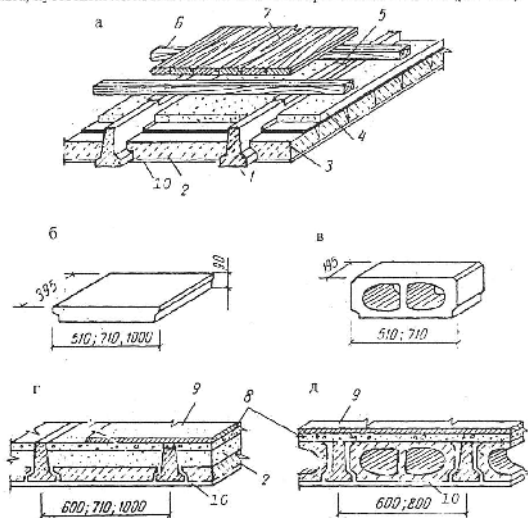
Сборные железобетонные балочные перекрытия: а – общий вид; б – железобетонная плита; в – легкобетонный камень вкладыш; г, д – варианты решений перекрытия; 1 – железобетонная балка; 2 – накат из легкобетонных плит; 3 – гидроизоляционный слой; 4 – звукоизоляция; 5 – звукоизоляционная прокладка; 6 – лаги; 7 – длинный лаг; 8 – выравнивающая стяжка из цементно-песчаного раствора; 9 – покрытие пола; 10 – затирка цементным раствором
